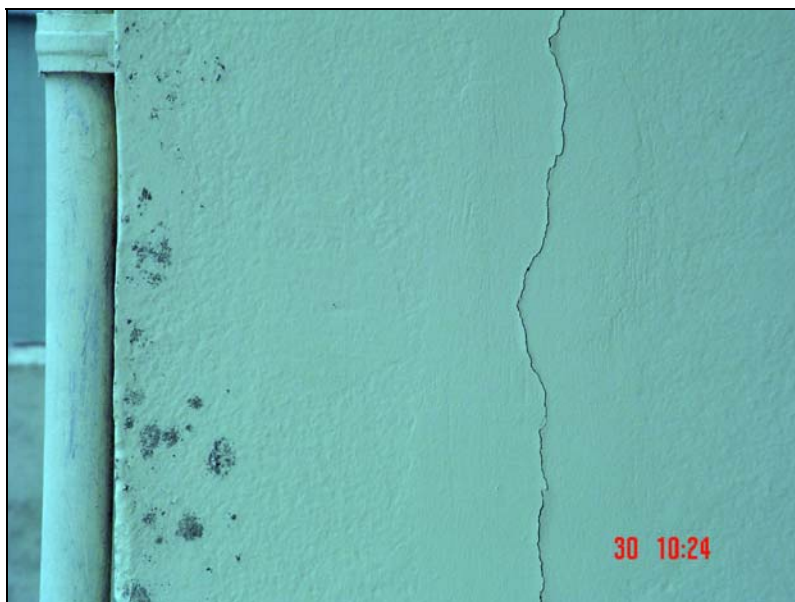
Fissura na interface da alvenaria com pilar
